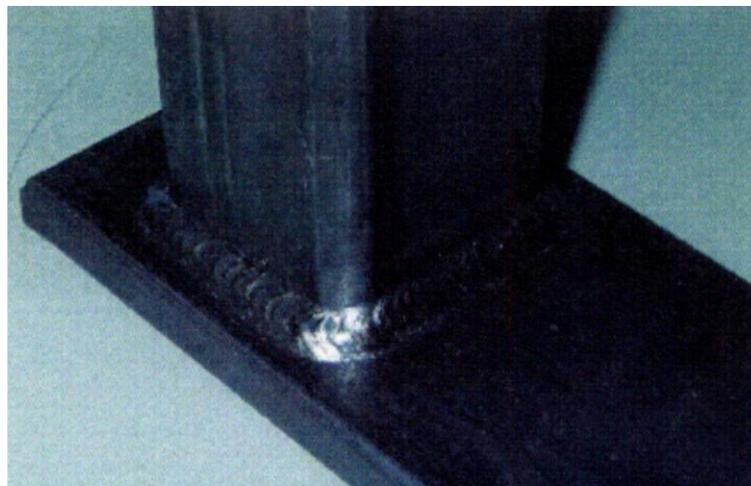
Ligação soldada em estrutura metálica- exemplo de conexão preenchida.
